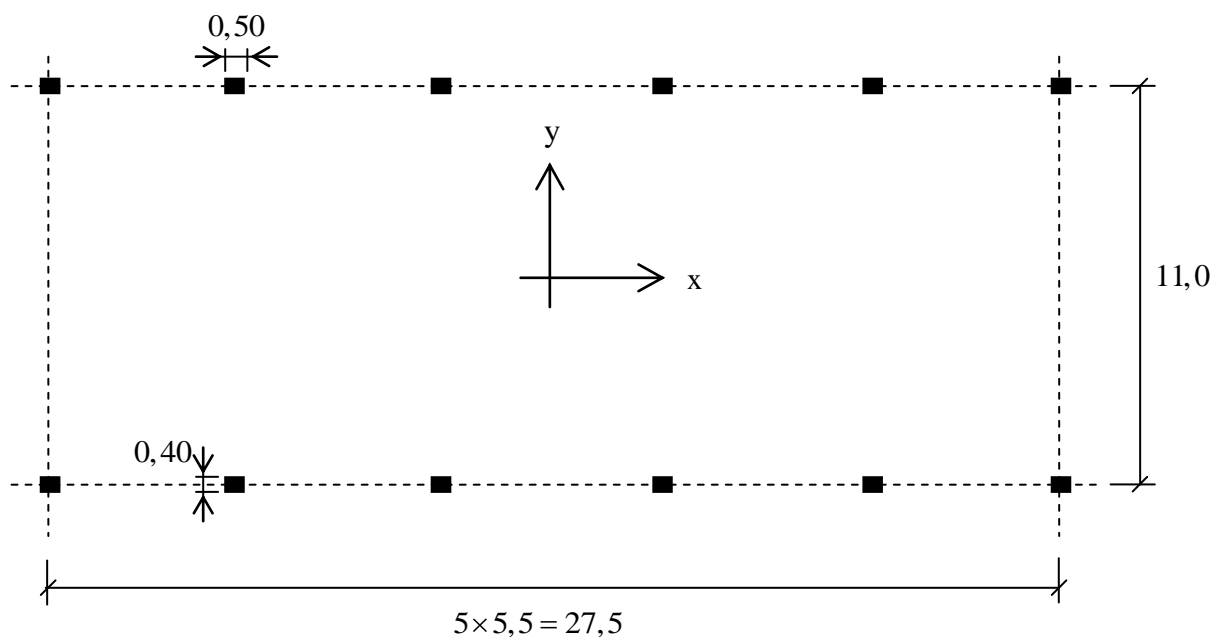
Disposição em planta das colunas (dimensões em m).
